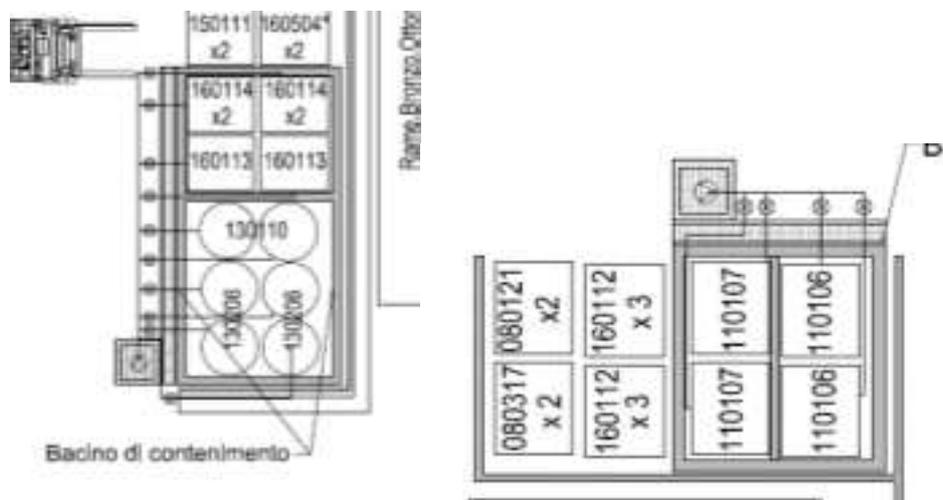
Straccio planimetrico relativo allo stoccaggio dei rifiuti liquidi all'interno del capannone
